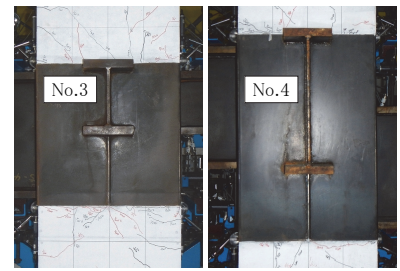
ひび割れ状況( $R = +2.0\%$ 時)
